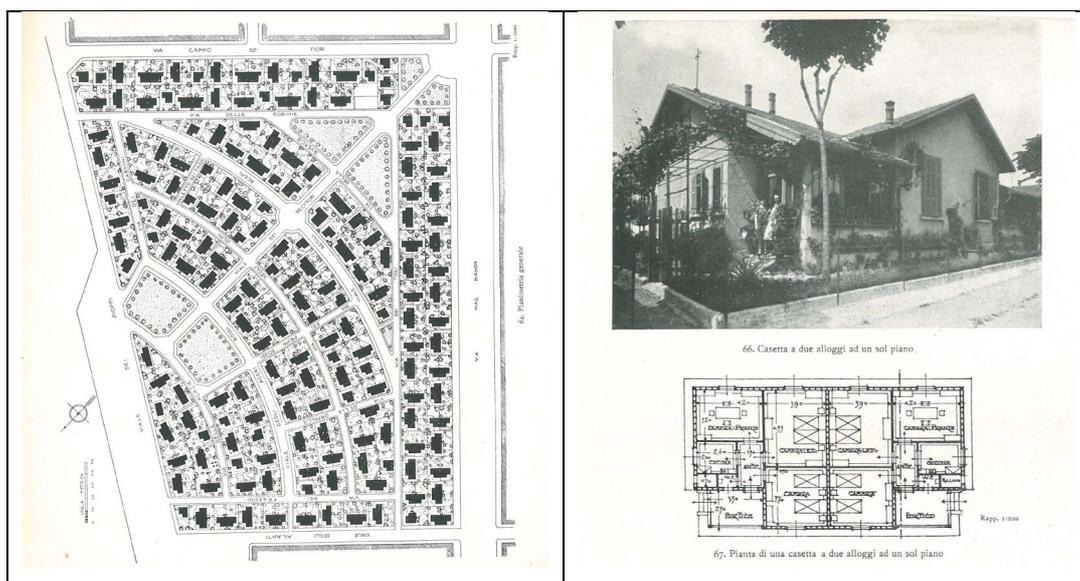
Villaggio Giardino Campo dei Fiori. Planimetria. Foto e pianta di un villino
